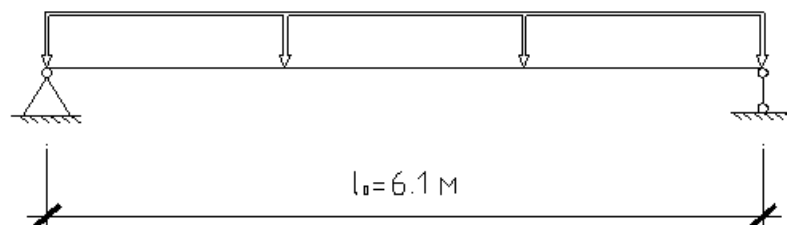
Схема завантаження багатопустотної панелі перекриття.
